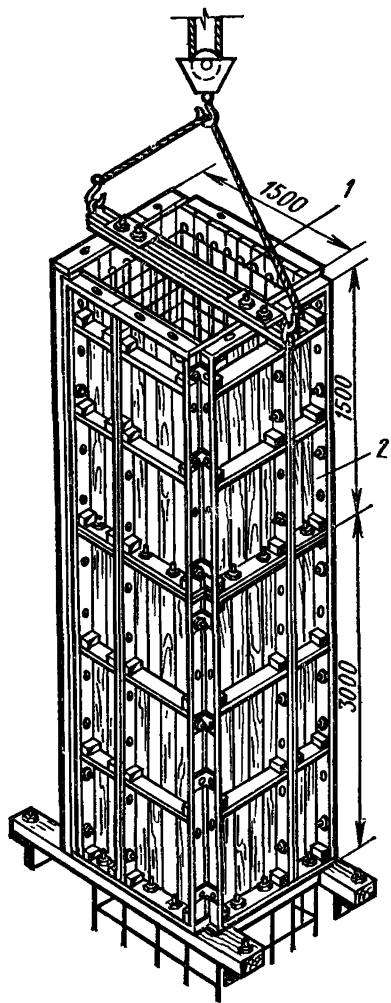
Арматурно-опалубочный блок подколонника во время монтажа:
